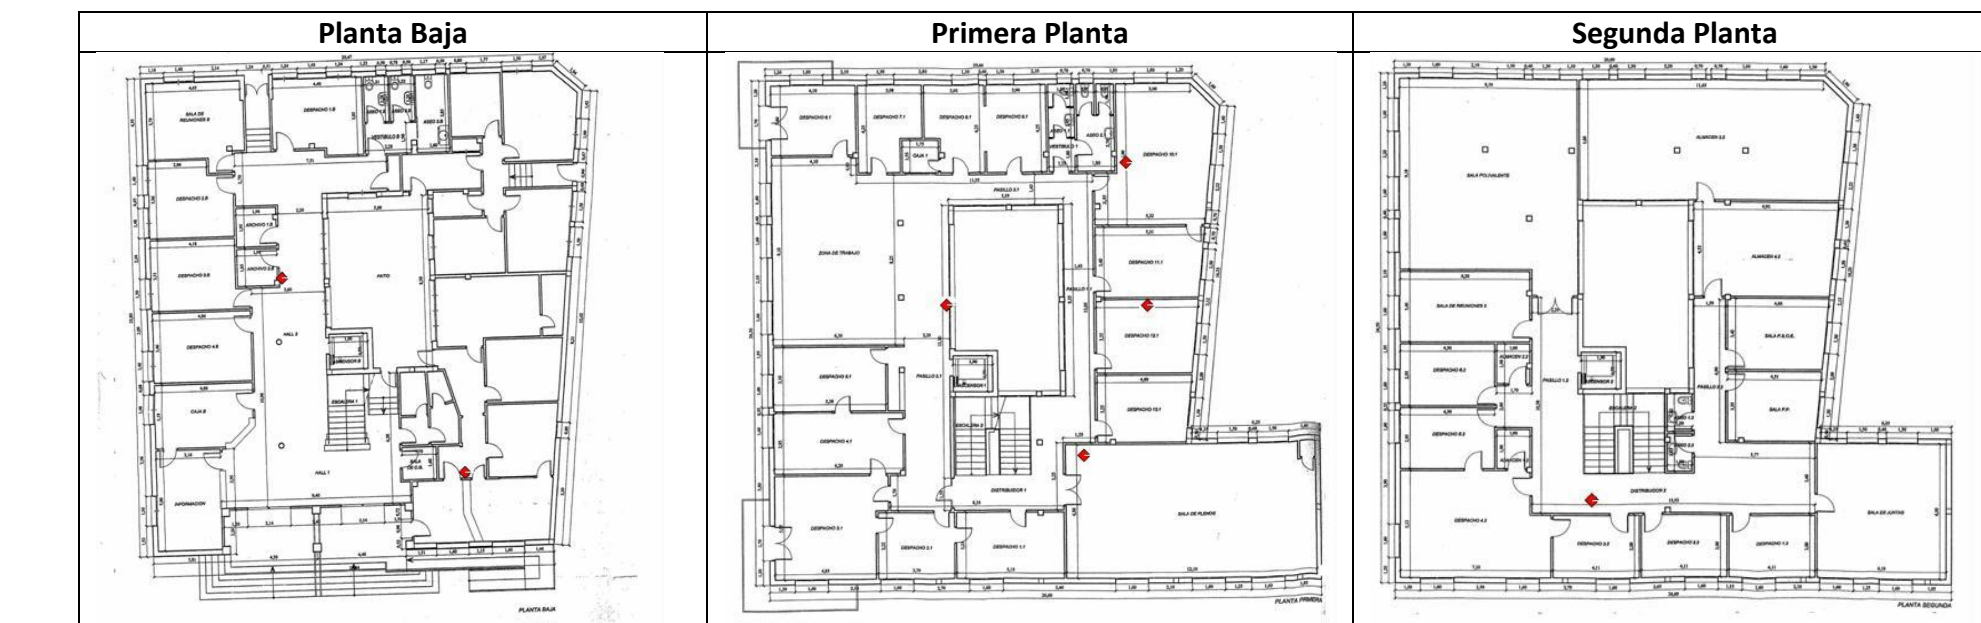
3.1 – Localización de puntos de acceso (Plantas Baja, Primera y Segunda)
